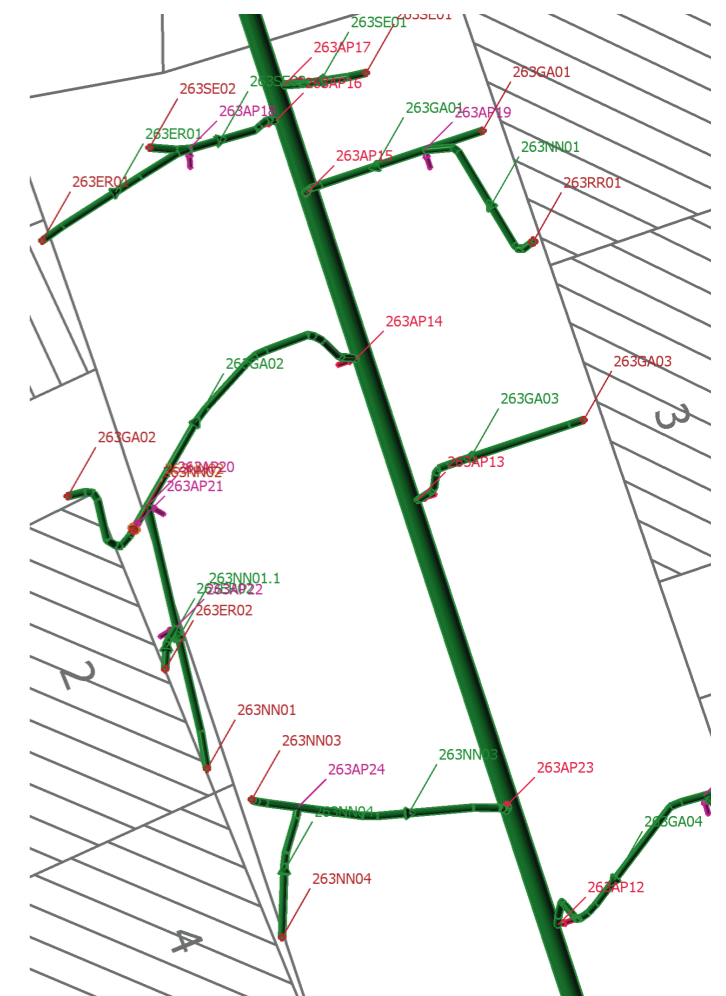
Im Grundriss; Erfassung des Leitungsverlaufs bei einer Neubaubauabnahme Kanalanschlussleitungen
